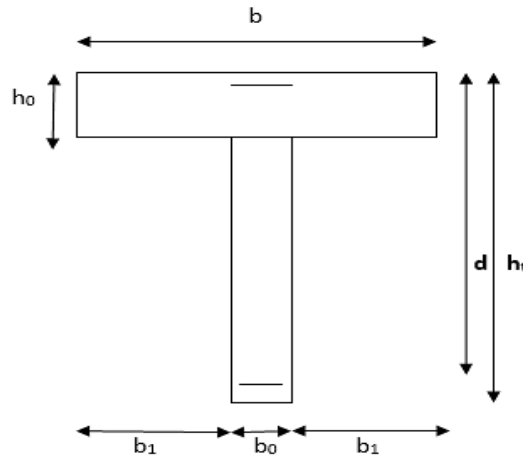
Section de calcul de la poutrelle après coulage de la dalle de compression.
